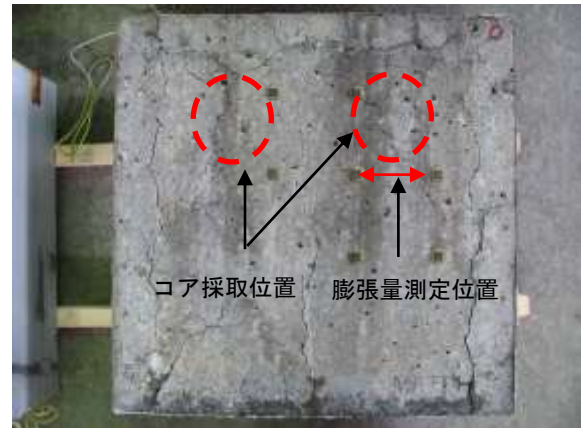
RC 試験体のひび割れ状況（暴露期間 6 年）
